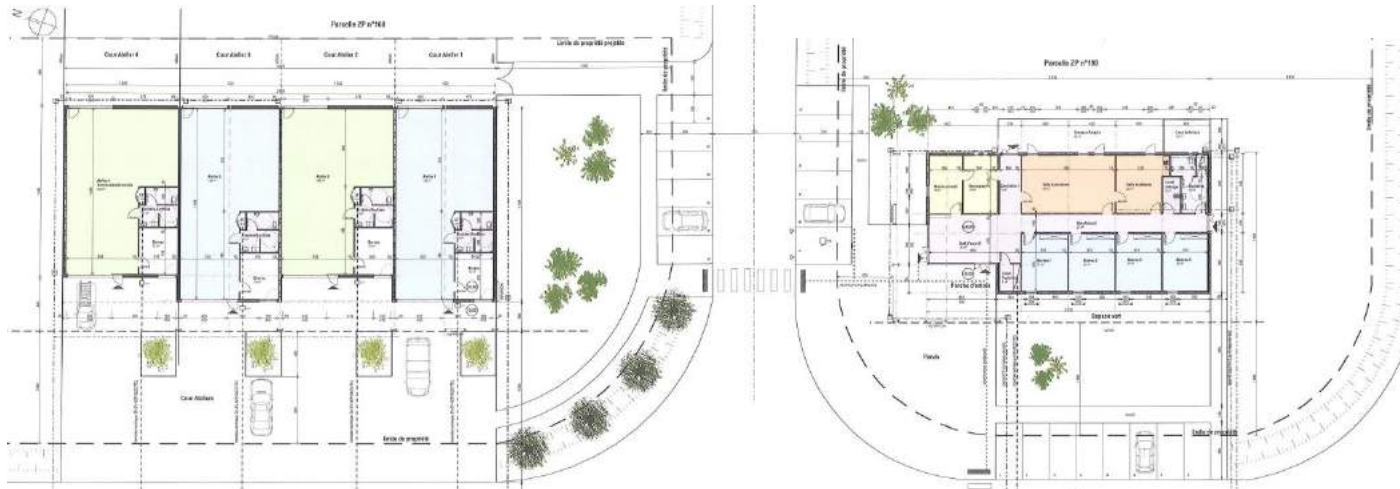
Plan du projet de village d'entreprises et d'artisans sur la ZAE de Gouneau, par Archi Studio.
